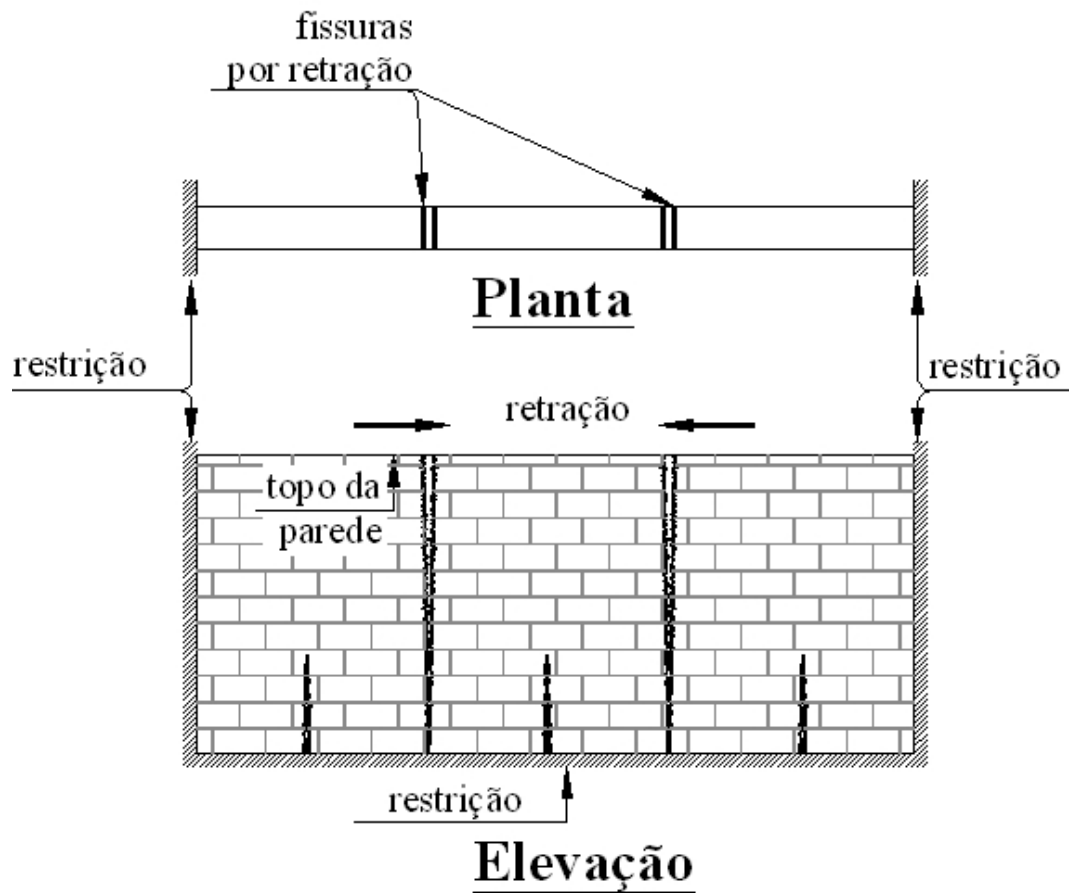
Condição típica para aparecimento de fissuras por retração (CURTIN et al., 1982)
